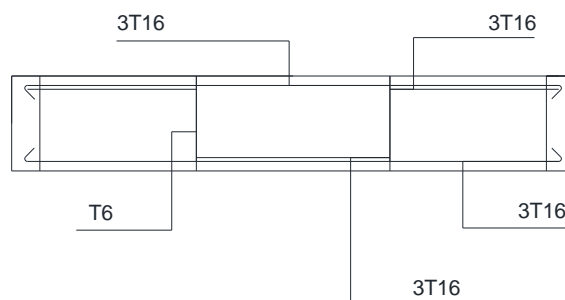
Coupe longitudinale d'une poutre secondaire 30x45cm (plan avec longues travées)
